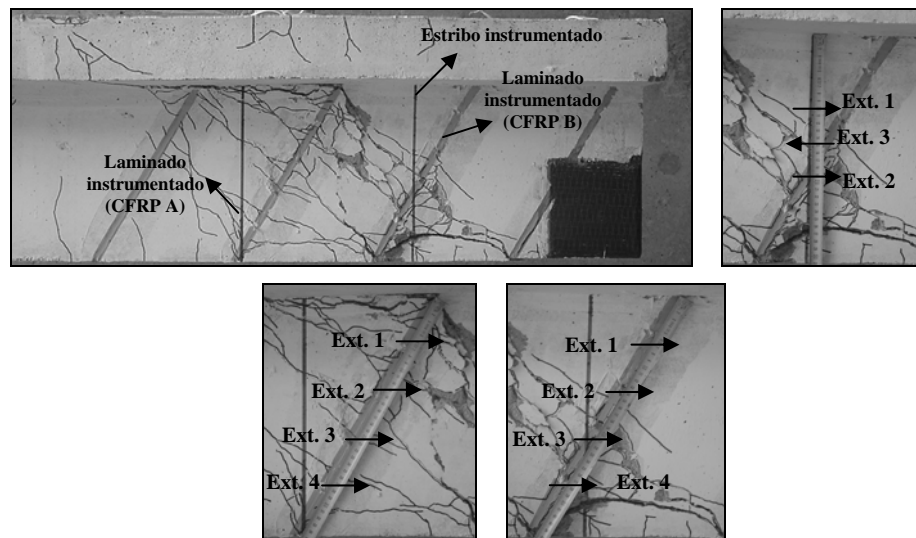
Localização dos extensómetros no laminado e estribo instrumentados da viga 2S-4LI60-B.
